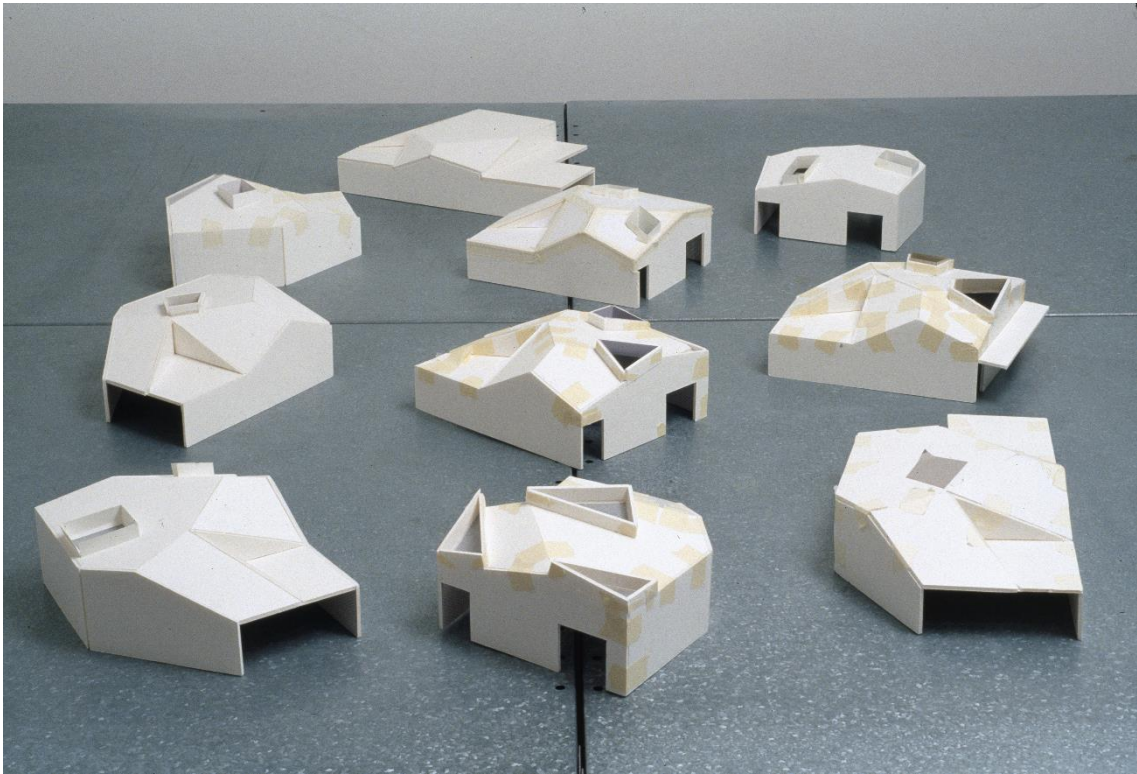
Fotografia de maquetas estudo da Brick House, 2005.
